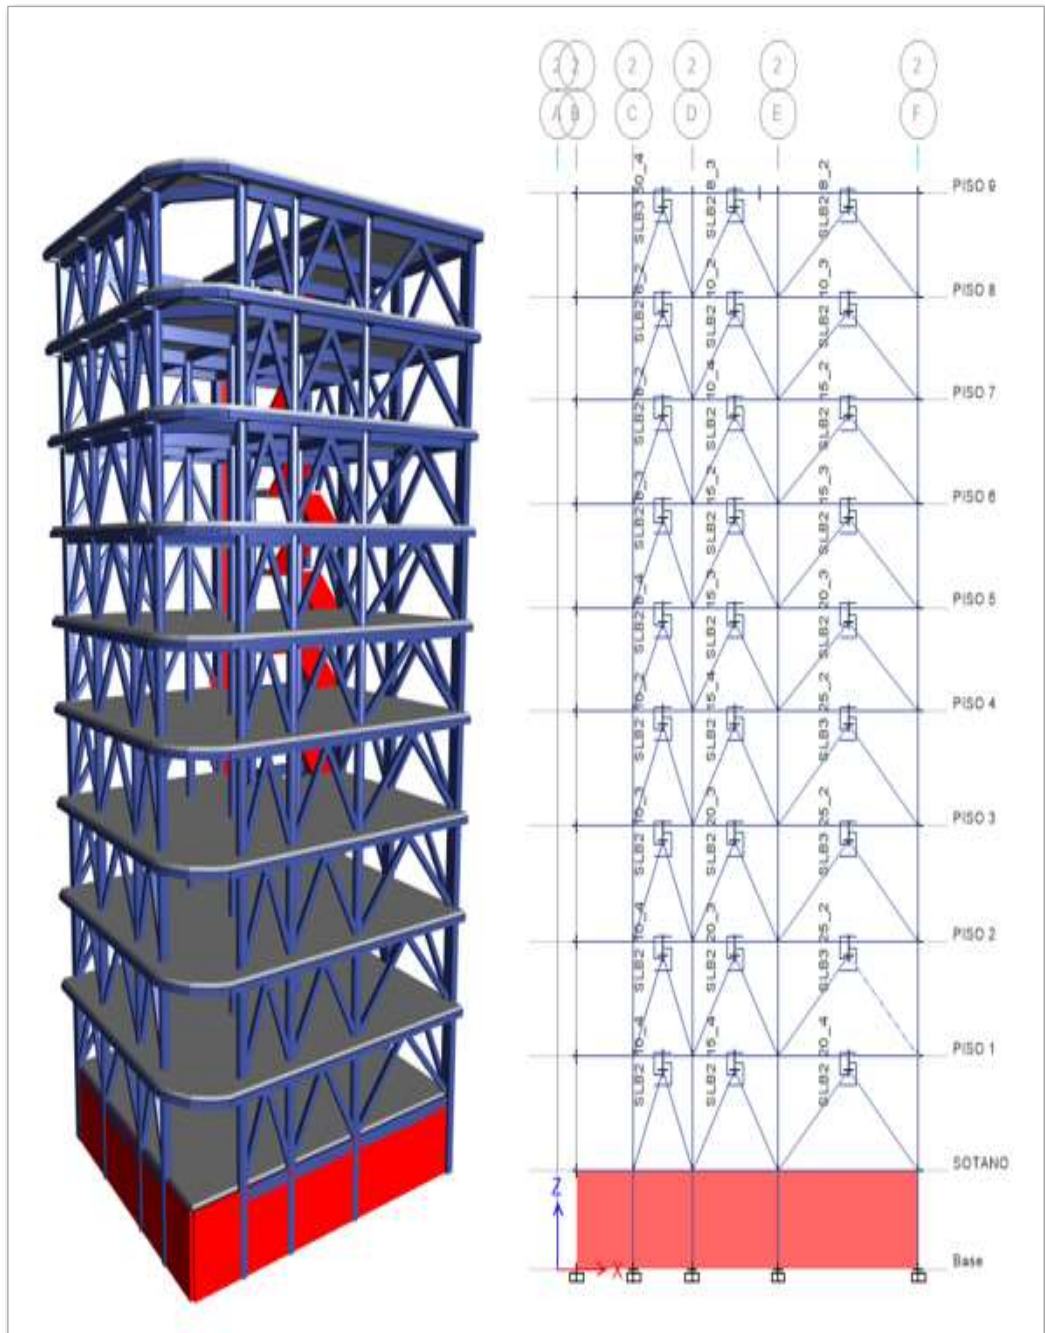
Vista en 3D con diagonales tipo chevron y asignación de SLB.
